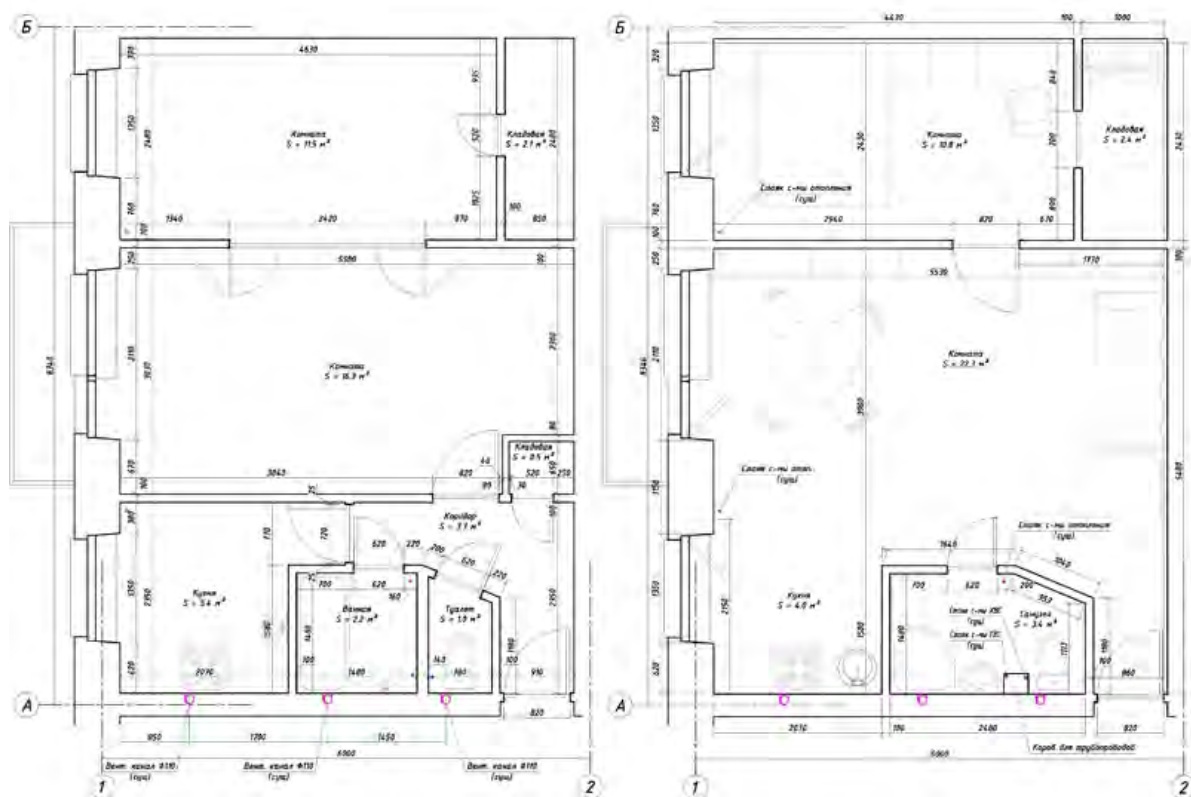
План квартири 2-го поверху жилого дома по вул. Пазгліс, 12/4 у Ризі: а - до реконструкції; б - після реконструкції
